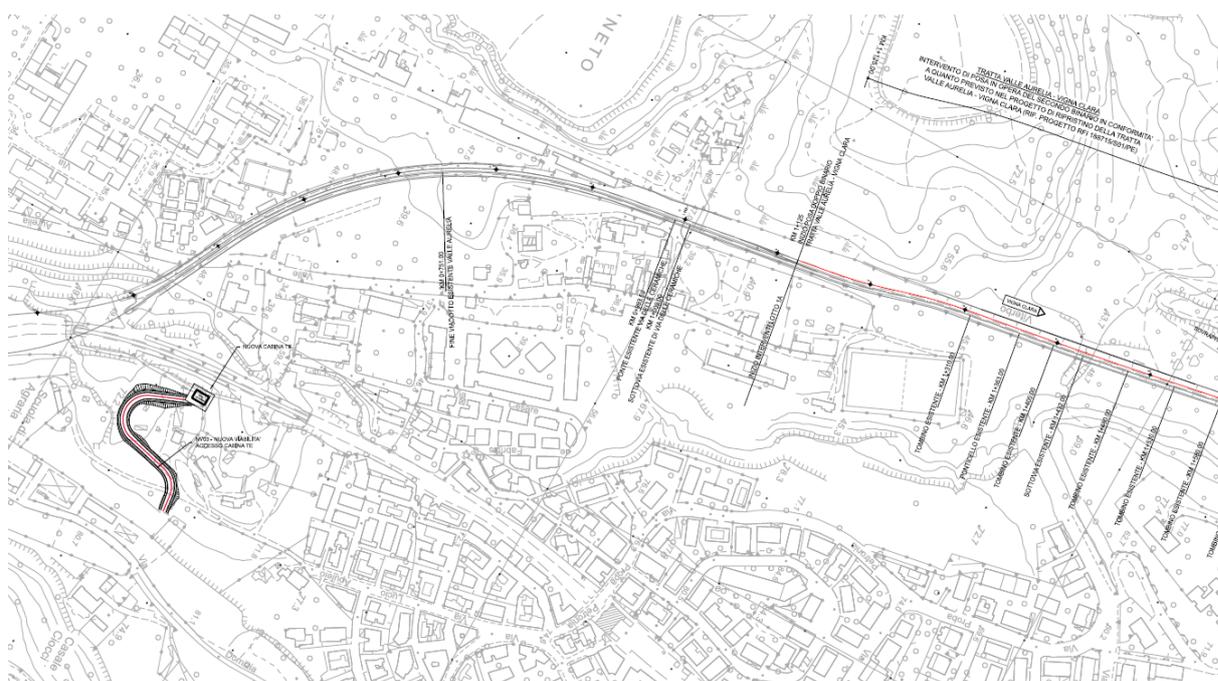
Intervento in progetto: stralcio planimetrico del tratto iniziale.
